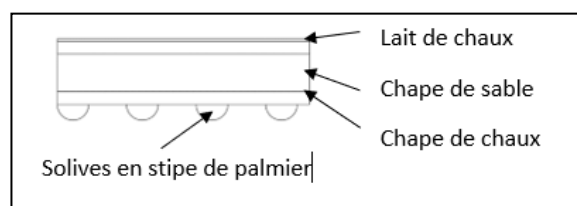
coupe de planchers. Source : fait par l'auteur
